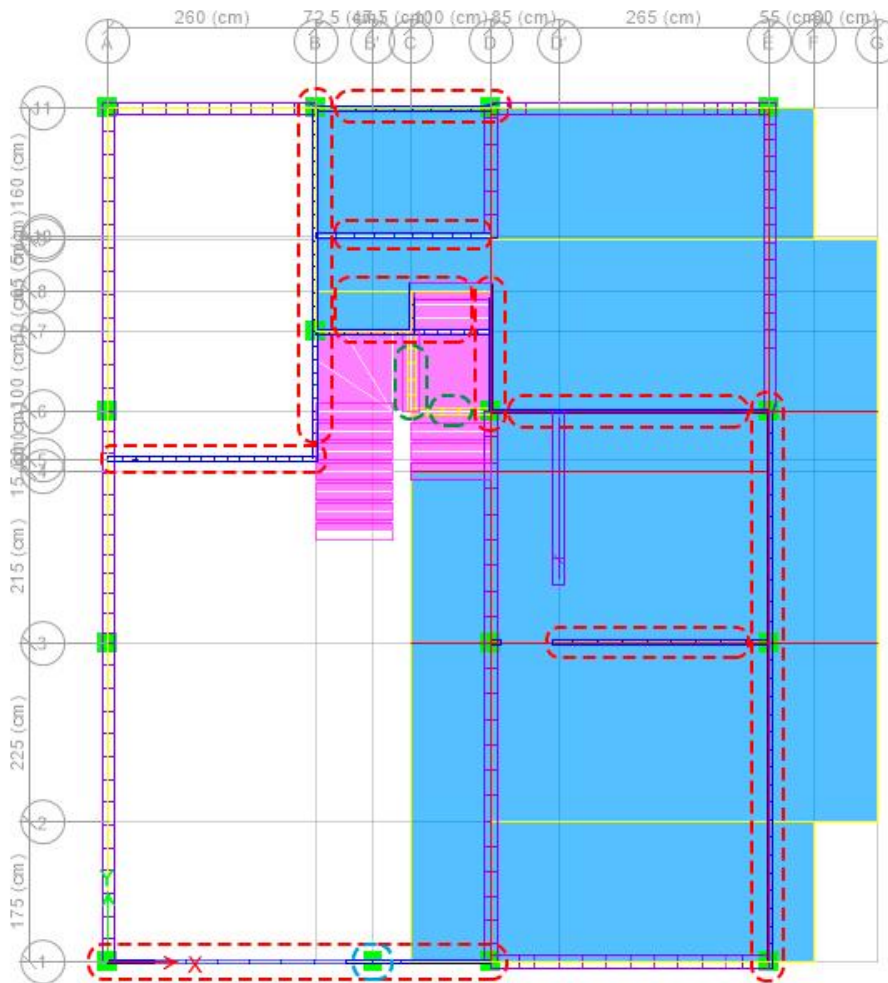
Esquema Estructural en Planta – Modelación N°3 ETABS 2016.
